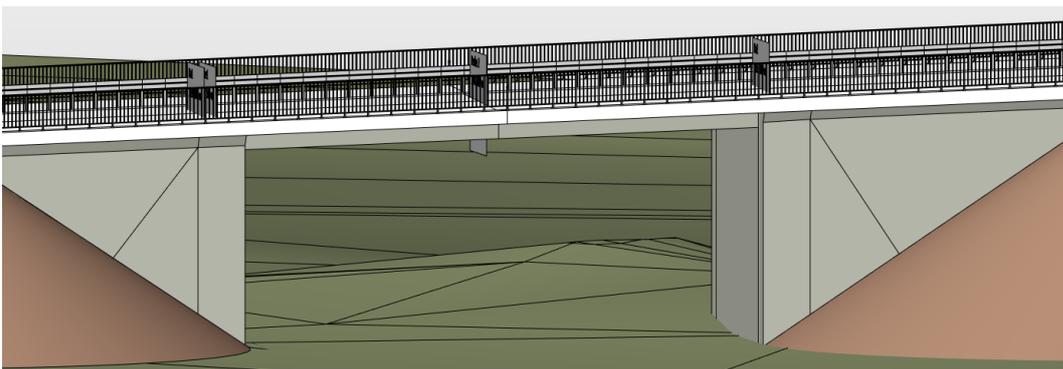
Ansicht Spannbetonfertigteilbrücke (eigene Darstellung)
